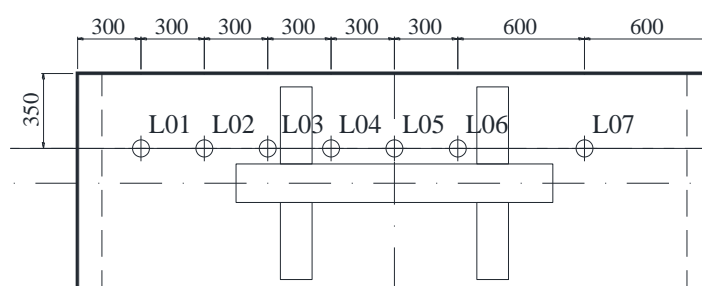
Posição dos LVDTs nas lajes (dimensões em mm)
